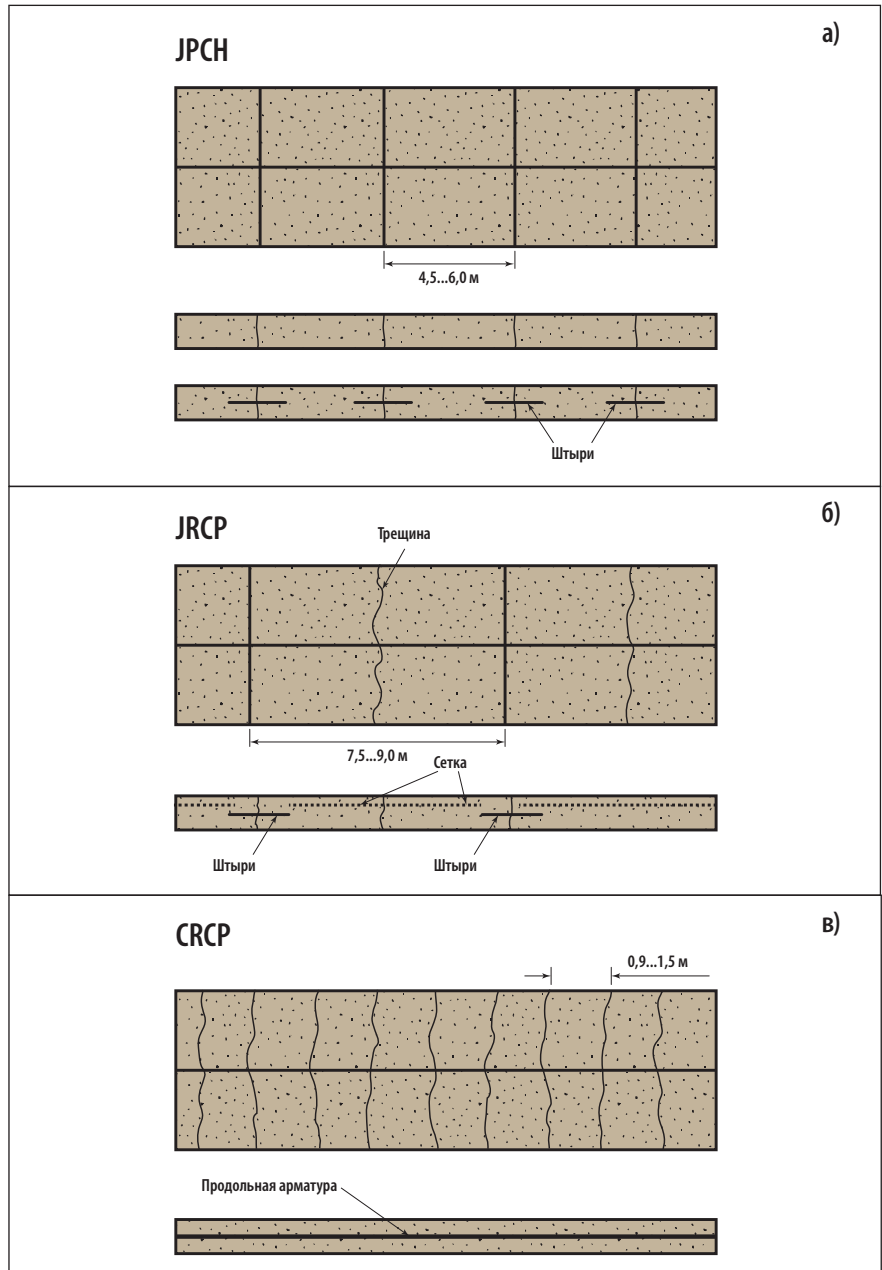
Три типа конструкций жестких дорожных одежд [4]: а – простые со швами; б – армированные со швами; в – непрерывно армированные
